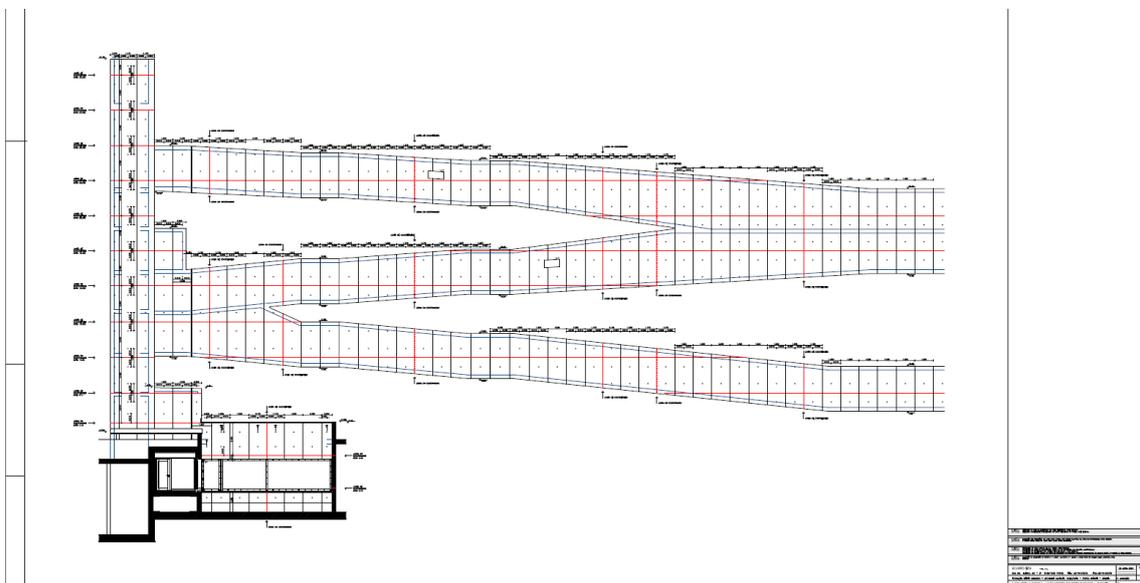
Facha Norte e Leste. Alçada Exterior das Rampas Planificada. Paginação.
